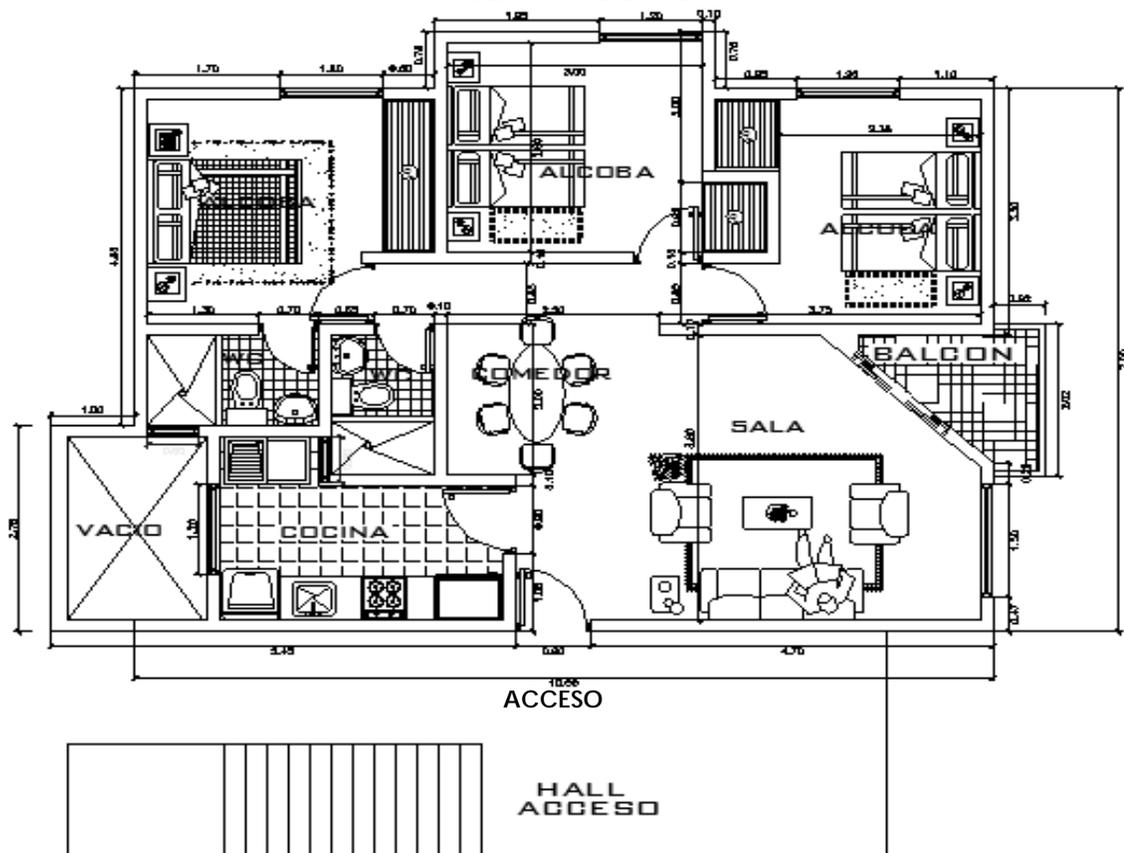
Plano Arquitectónico Apartamento La Raquelita
